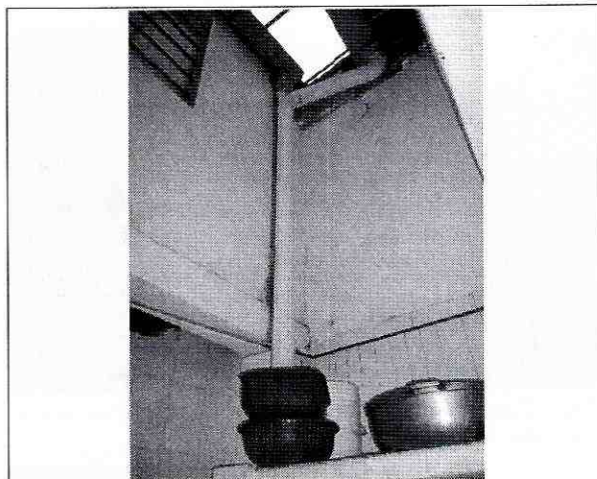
Estado actual de las bajantes de la edificación en la parte intermedia. Se observa una separación de la bajante de los muros de la segunda planta piso hacia la parte sur occidental de la edificación.
